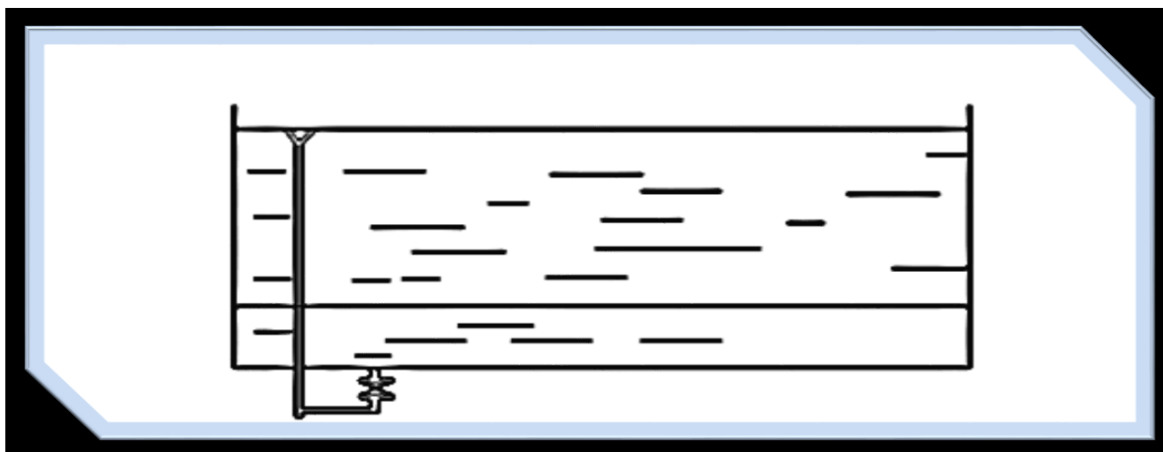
Conduite de trop-plein et de vidange [6]
